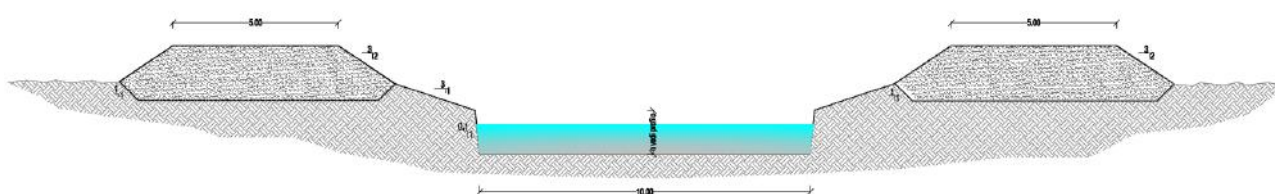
Sezione lama Scorbeto tratto arginato
